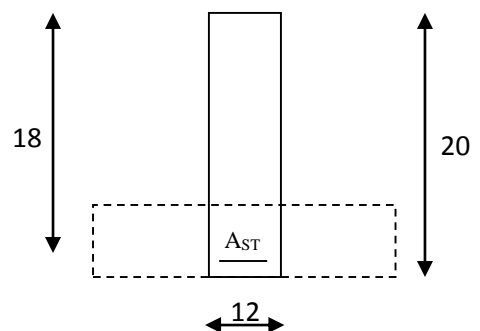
section de calcul de la poutrelle aux appuis
